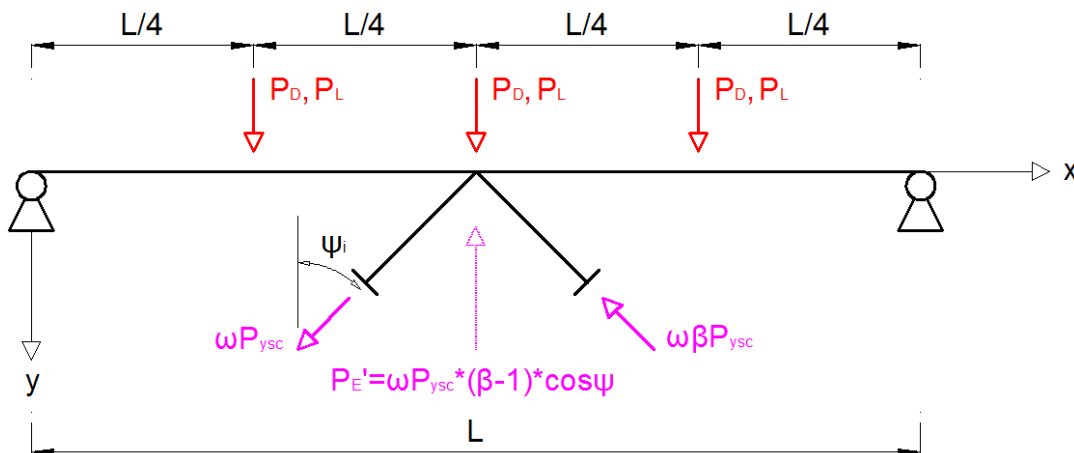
Cargas aplicadas en una viga del sistema BRBF.
